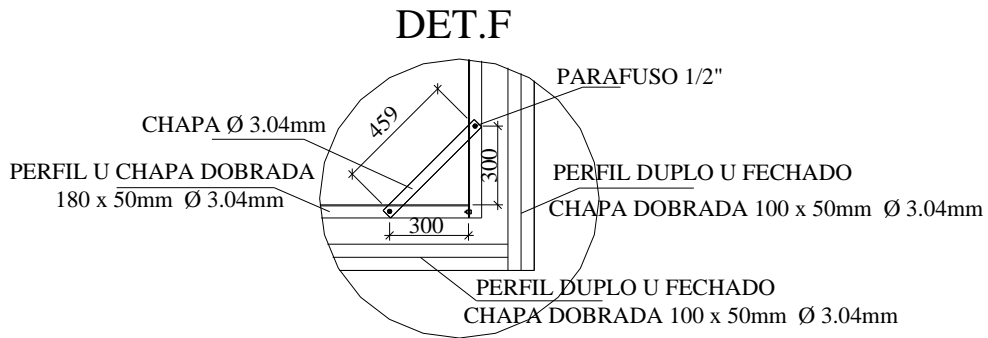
Detalhe F do projeto da fôrma metálica.
